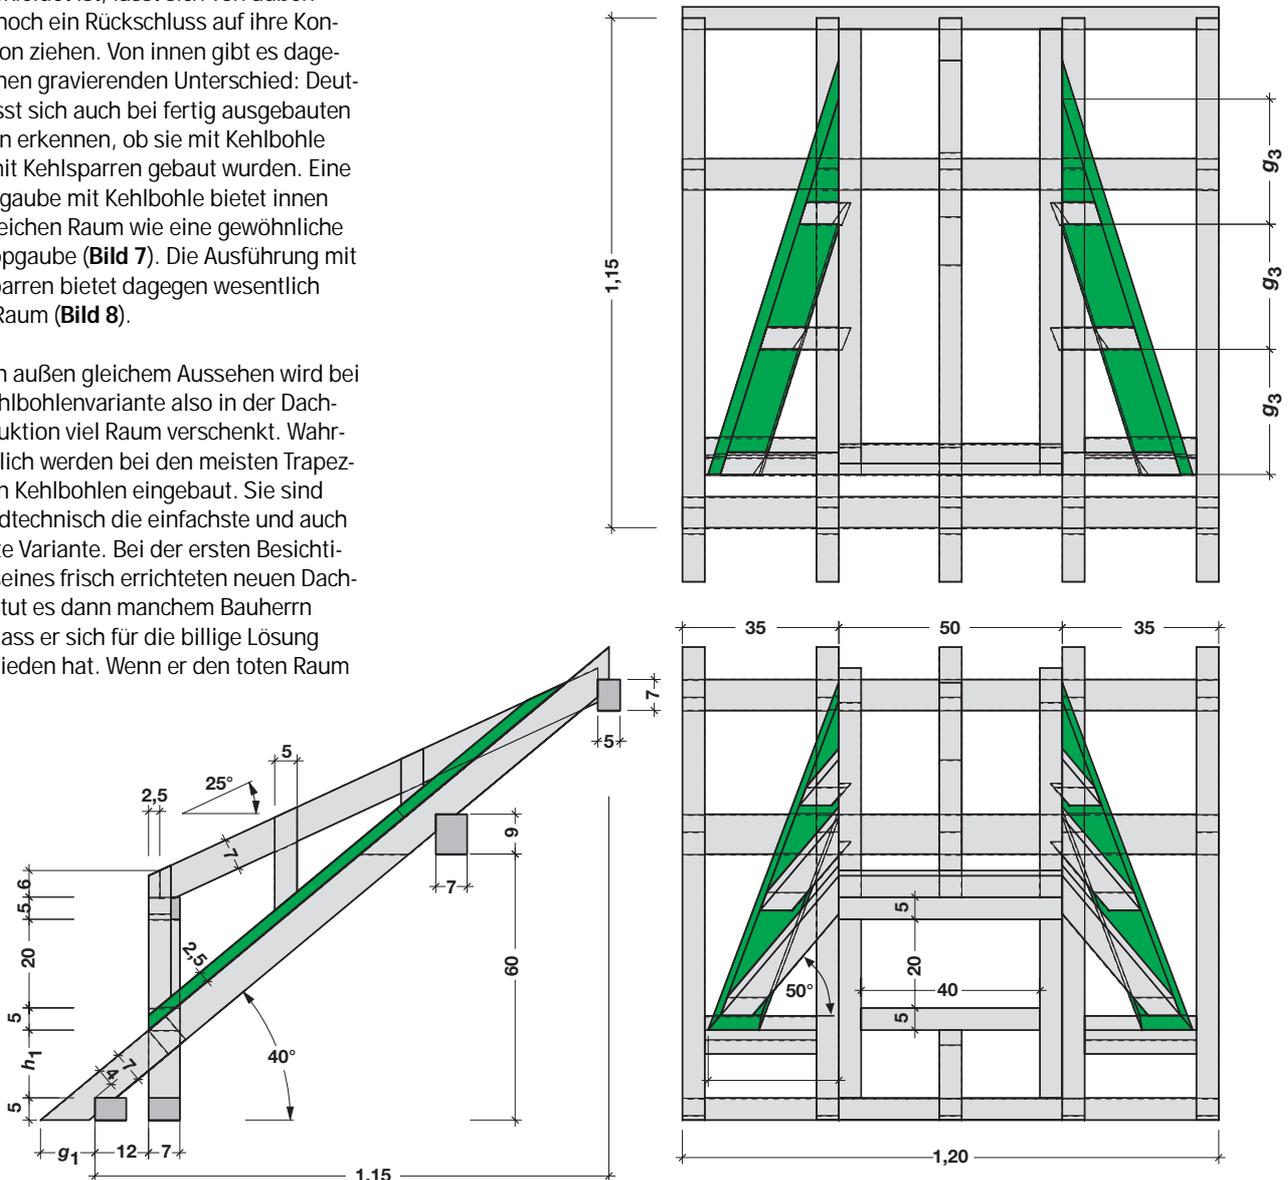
Grundriss, Vorderansicht und Profil der Trapezgaube mit den Maßen zur Herstellung eines Modells
